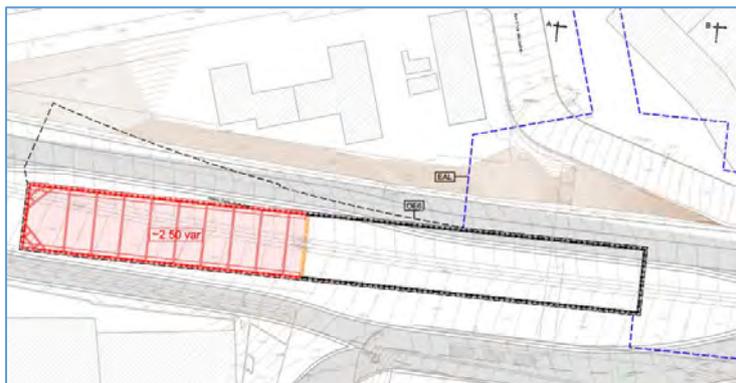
Planta de Dimensionamento Contenção Provisória - 2ª Fase de escavação
